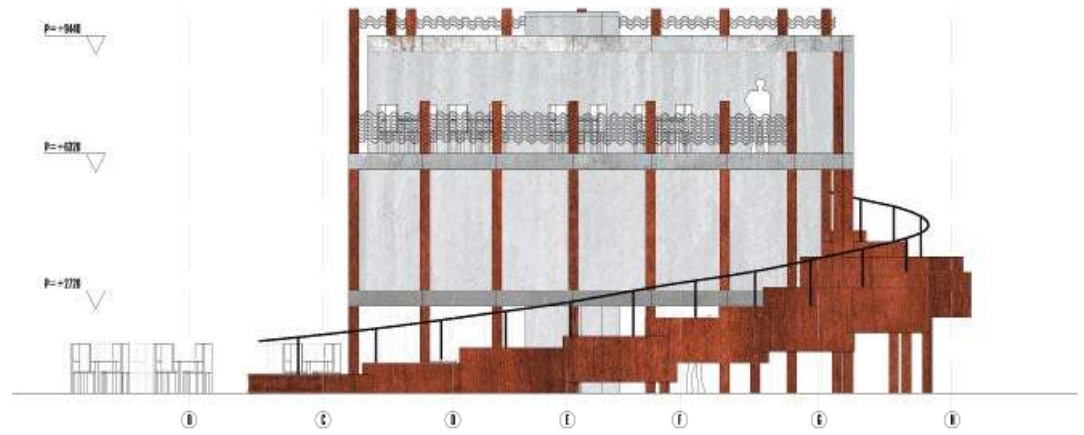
Doorsnede, 1:100, "Boskiek'n"
